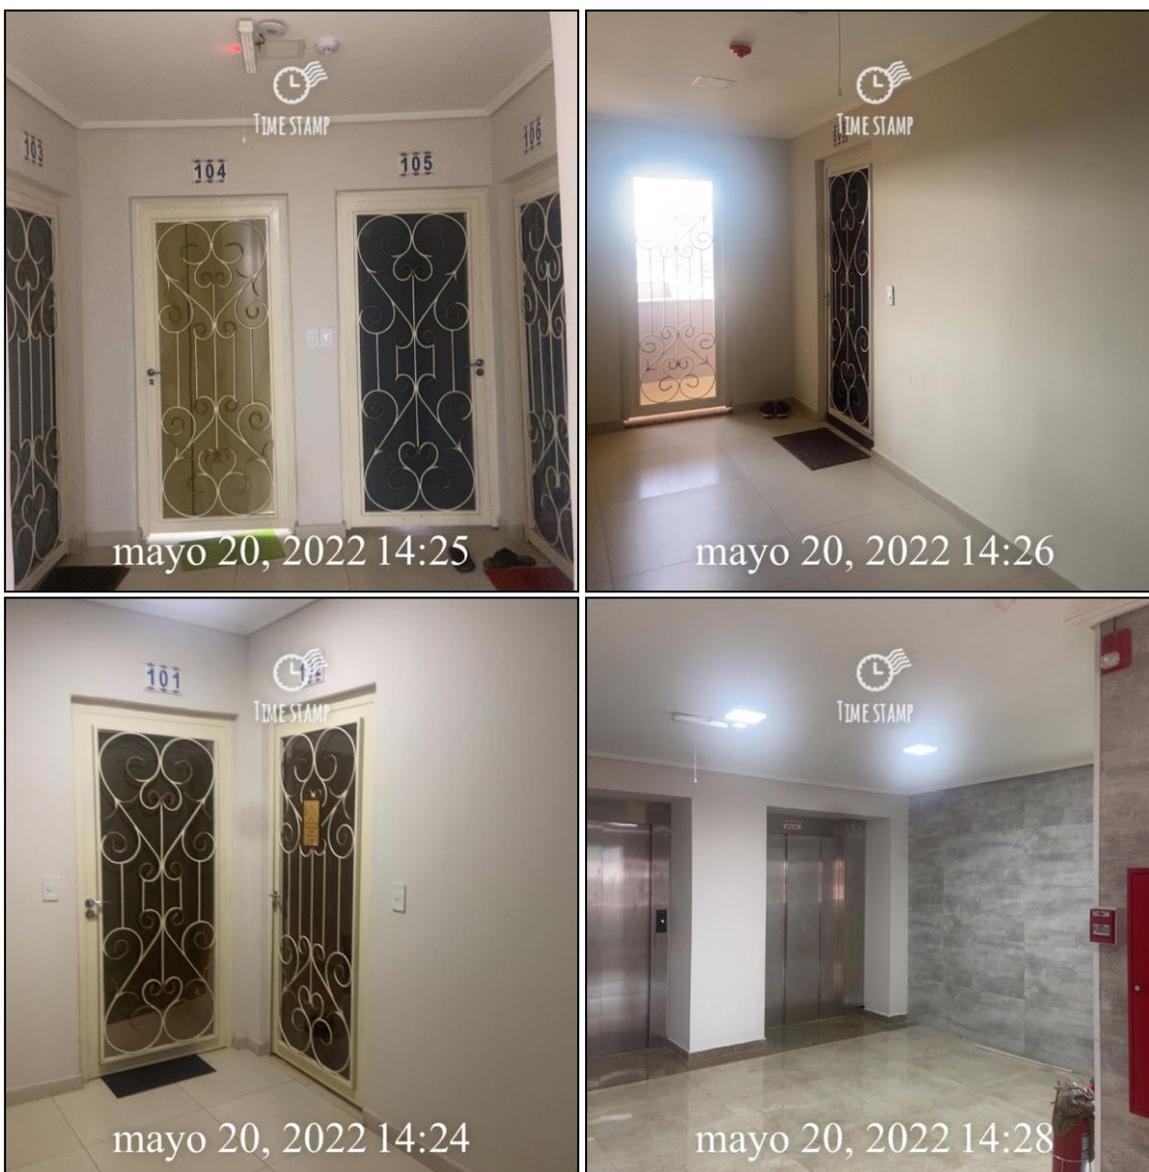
, 2, 3 y 4: Vista General del Edificio.
